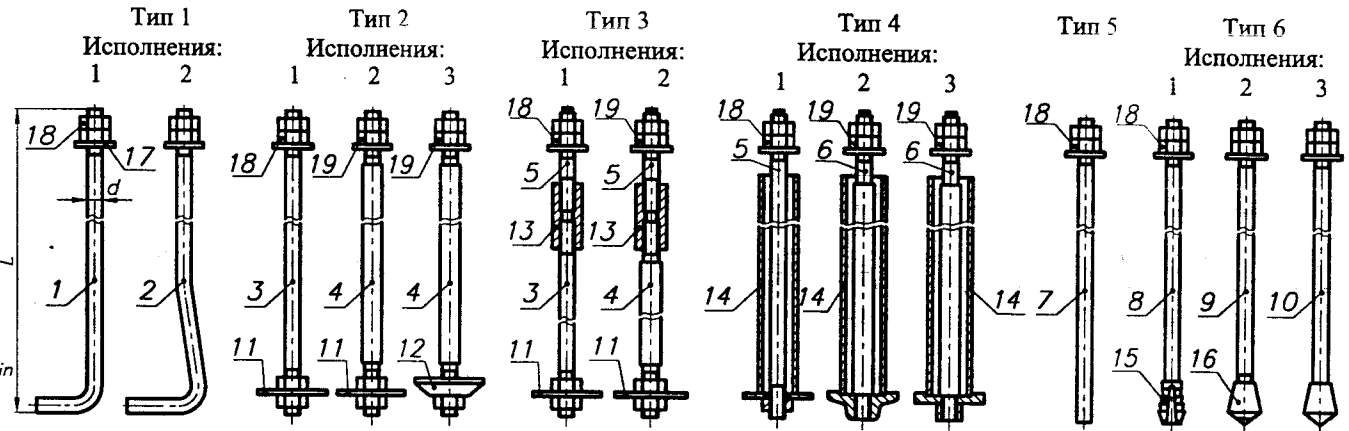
Типы и конструкция фундаментных болтов:
